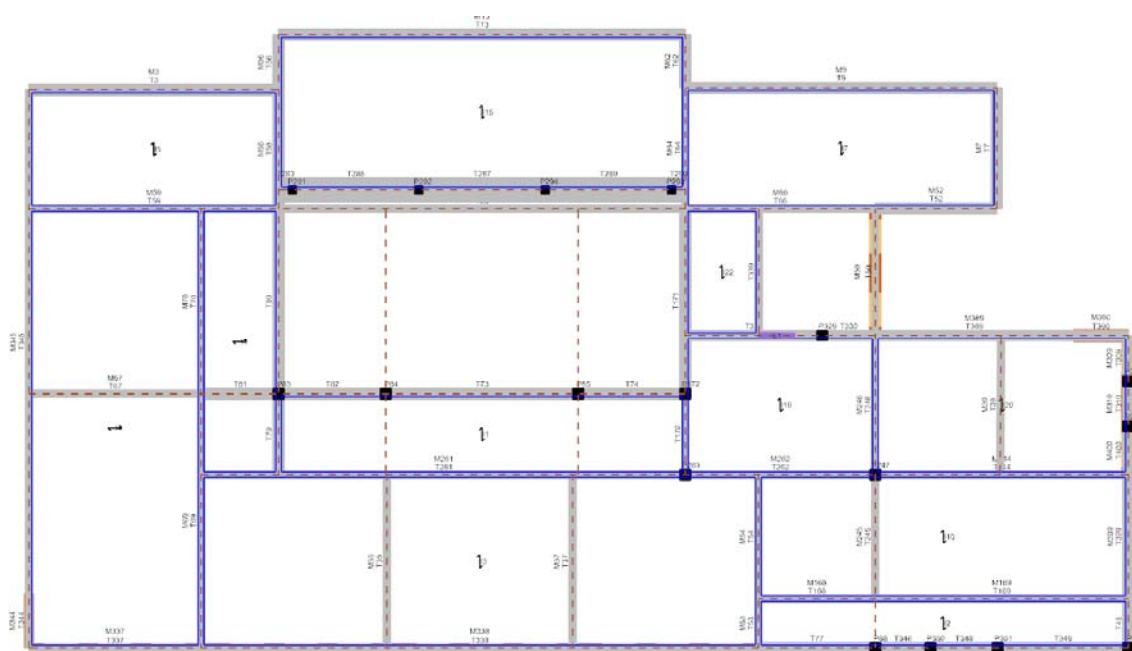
pianta livello 1 con numerazione maschi murari, pilastri, travi e solai.
